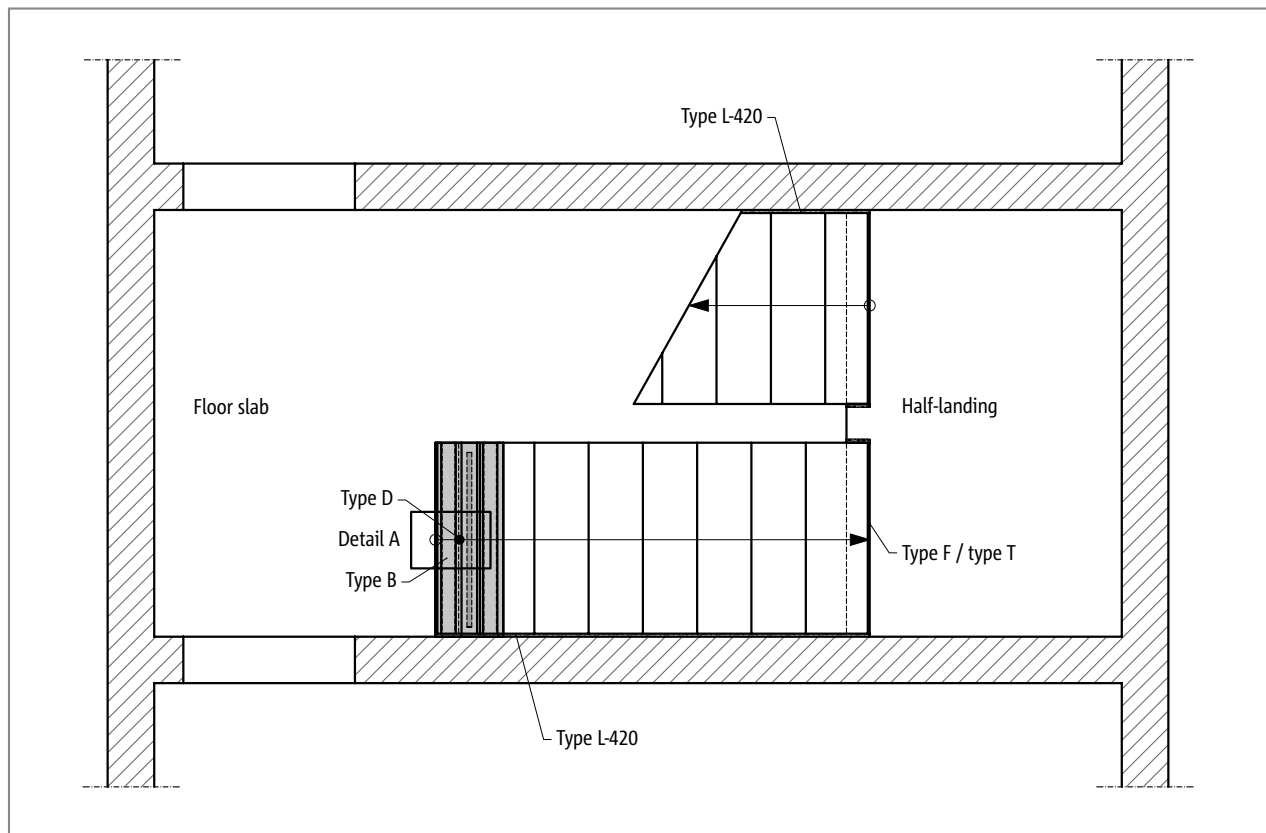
Schöck Tronsole® Type B + type D: Element configuration in plan view
